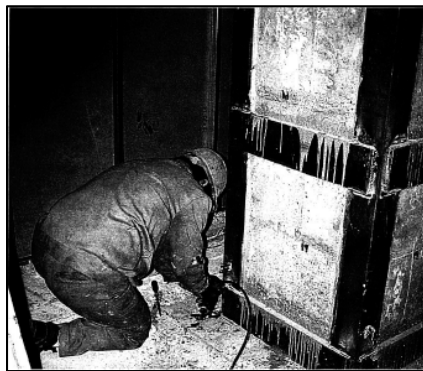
Refuerzo de columna mediante perfiles angulares y soleras encoladas con resinas epóxicas. (Rodríguez, 1998).
